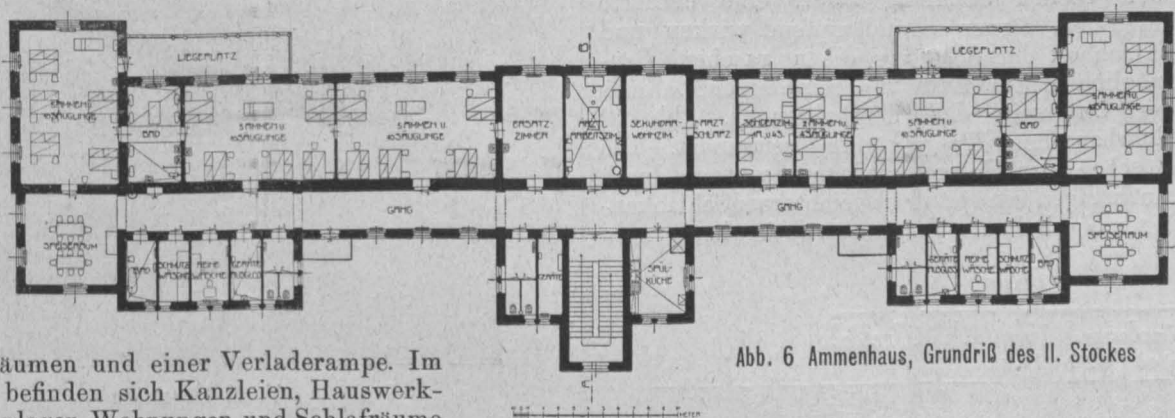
Ammenhaus, Grundriß des II. Stockes
